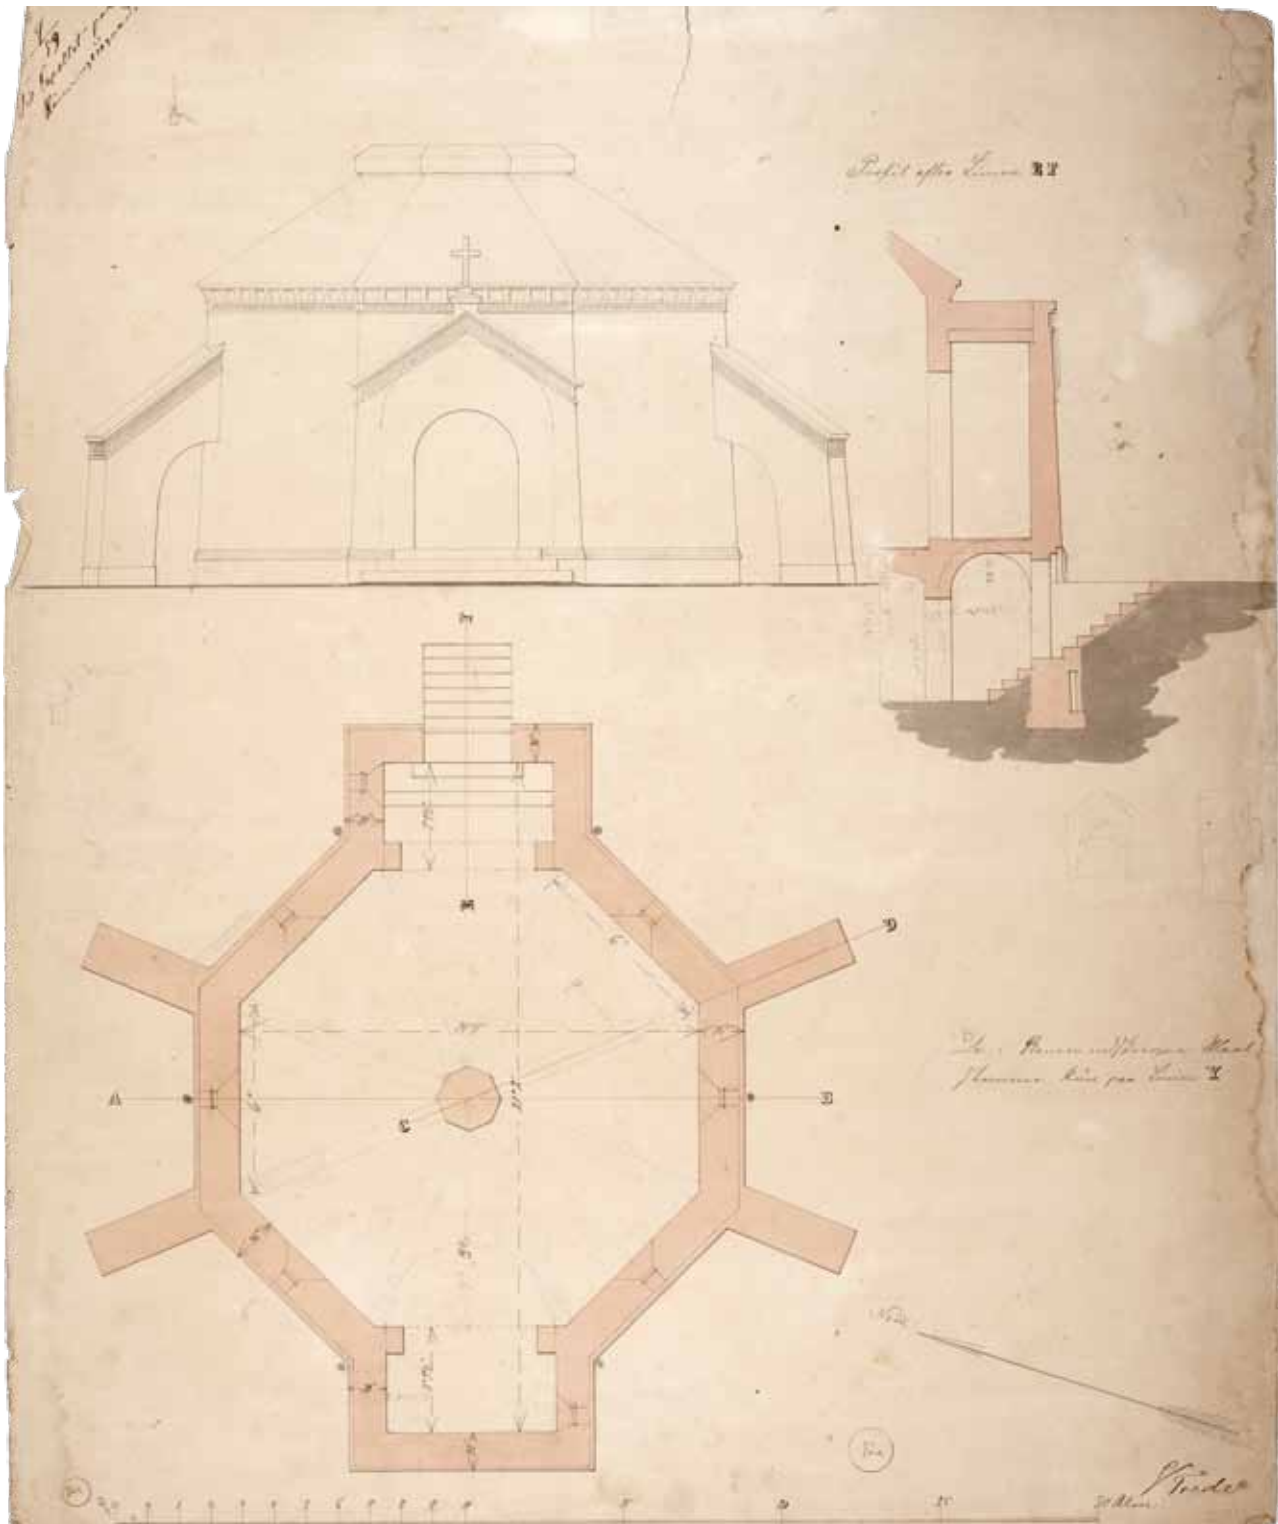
Plan af underetagen, opstalt af sydvestfacaden samt snit af 'koret'. 1:150. Tegninger ved V. Tvede, 1859. I Danmarks Kunstbibliotek. – Plan of lower floor, elevation of the south west facade and section of the 'chancel'.
